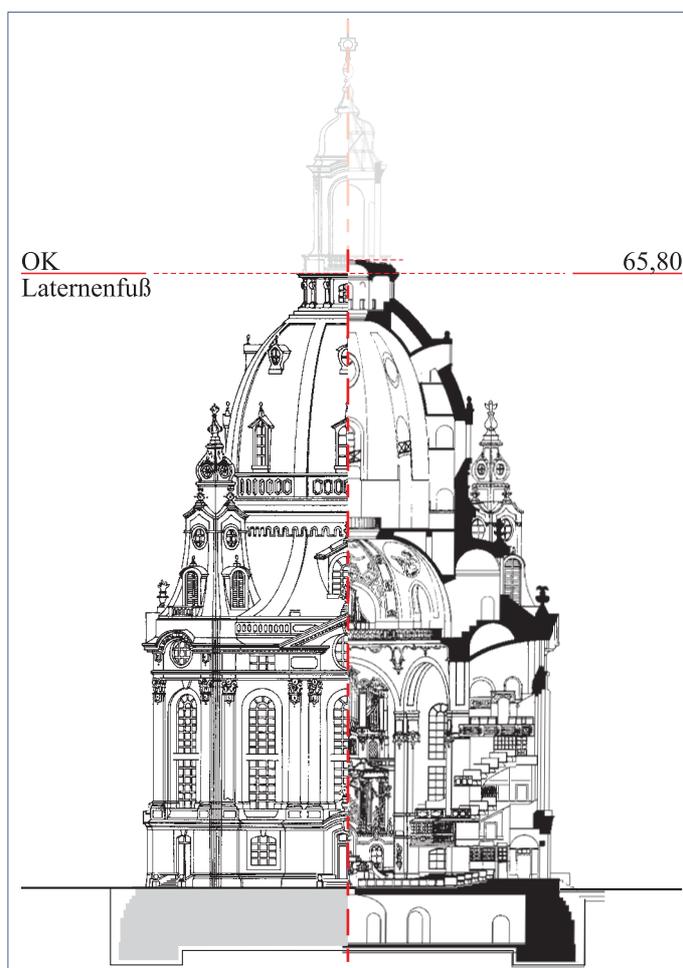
Der mindestens im März 1738 erreichte Bautenstand.²
